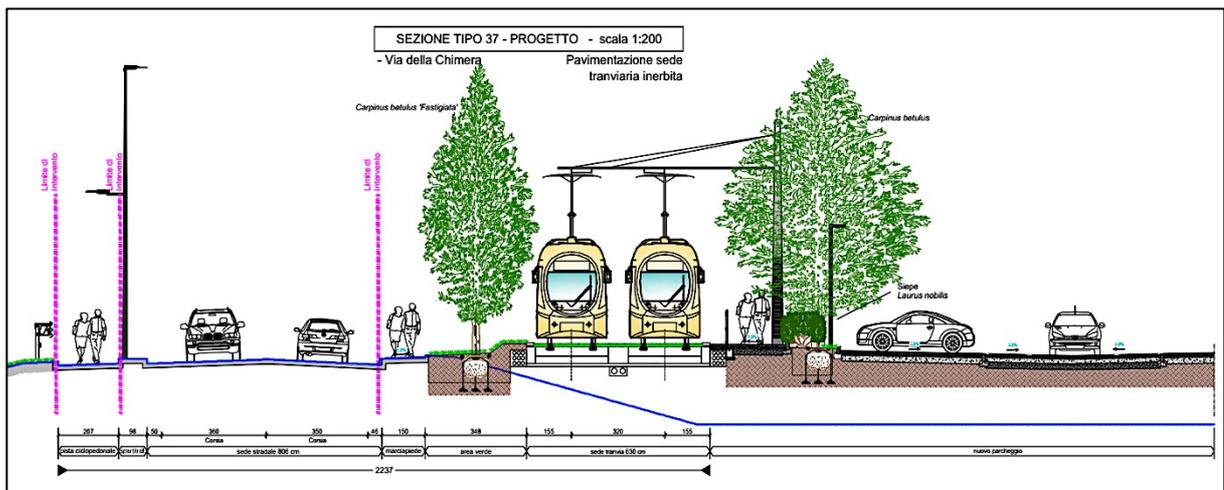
Sezione tipo via della Chimera e parcheggio scambiatore-Progetto
